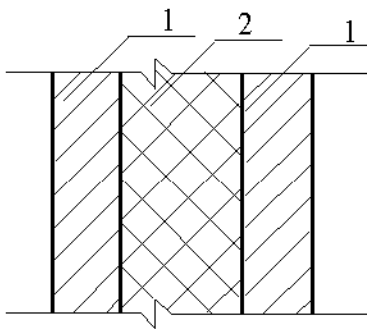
Конструкція стіни. 1- важкий бетон; 2 – мінераловатний утеплювач.
